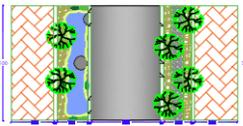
Detalle constructivo de pavimento permeable. Fuente: Elaboración propia.
